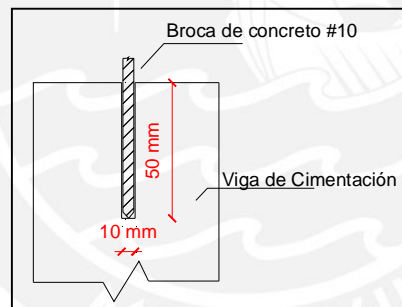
Corte transversal del anillo de cimentación para anclaje de refuerzo del murete M2.
